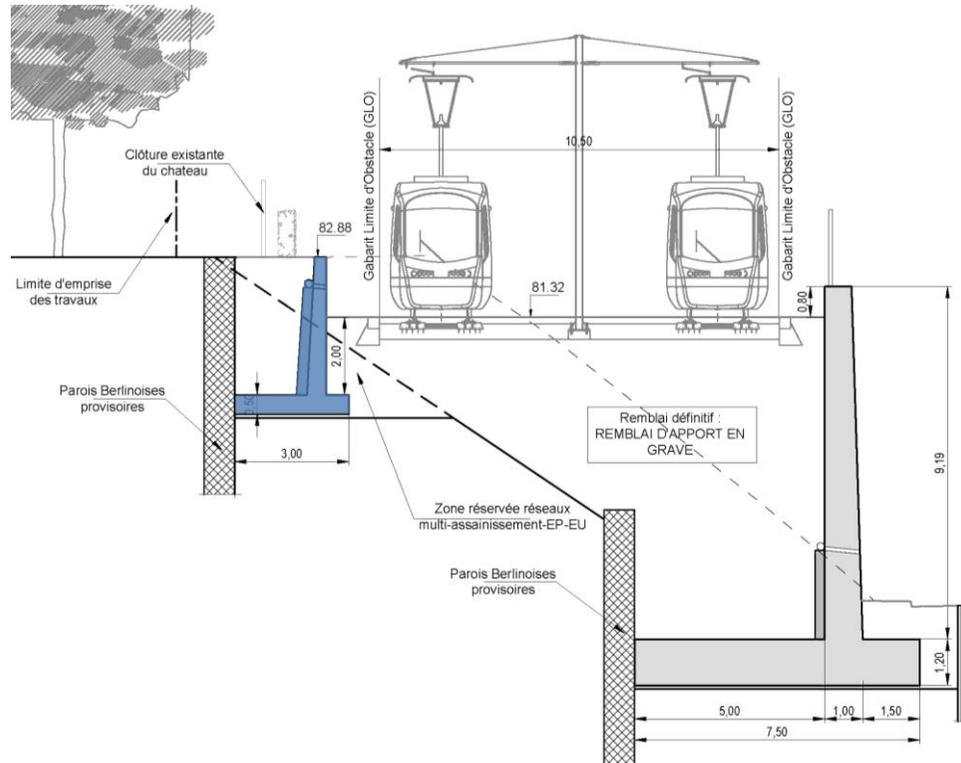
Coupe W – représentation du mur haut sur fondations superficielles
